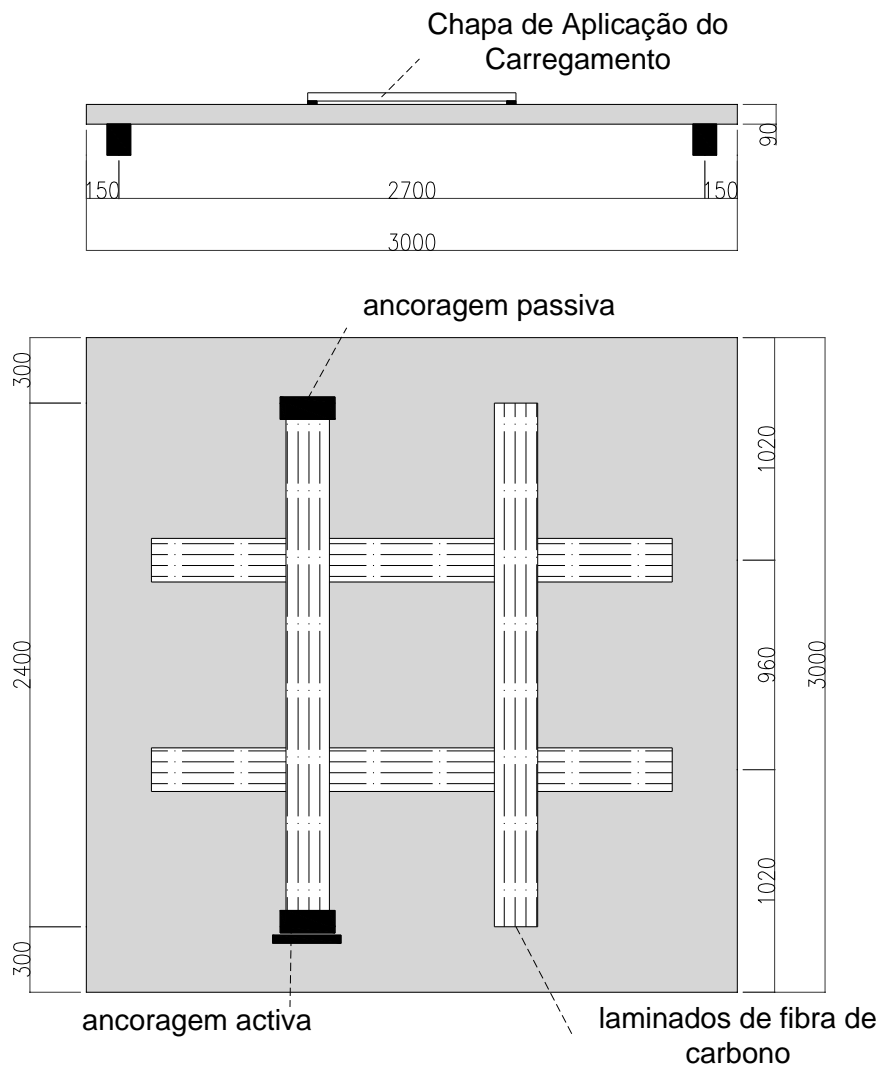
Esquema de ensaio, vista lateral e vista do reforço com CFRP [163]. (dimensões em mm)
